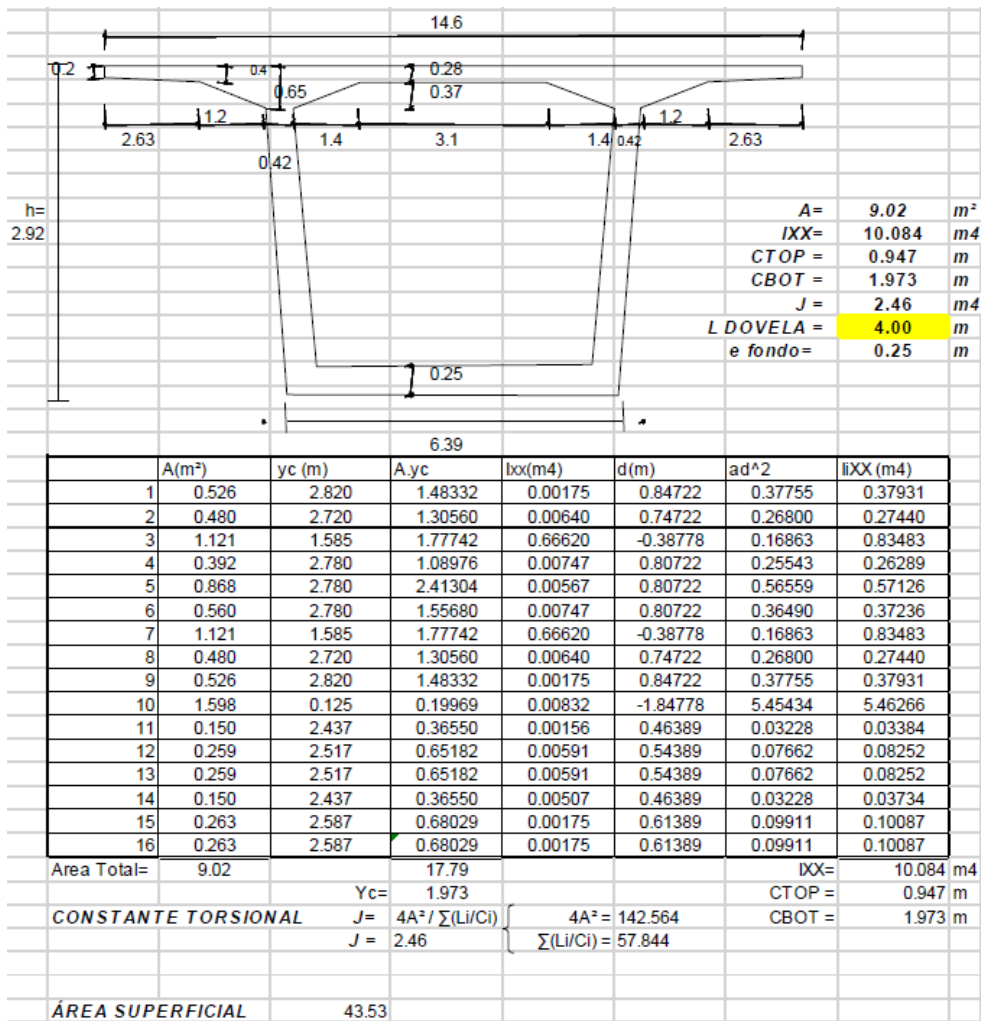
Dimensiones y propiedades de la viga cajón cara menor dovela 4 puente San Pedro.
